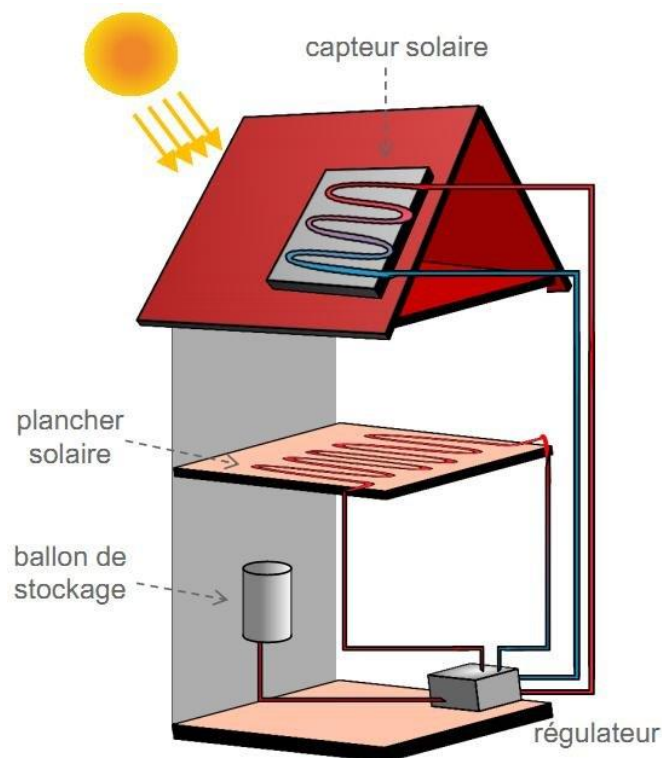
Principe du chauffage de bâtiment par plancher solaire direct (PSD).[16]
